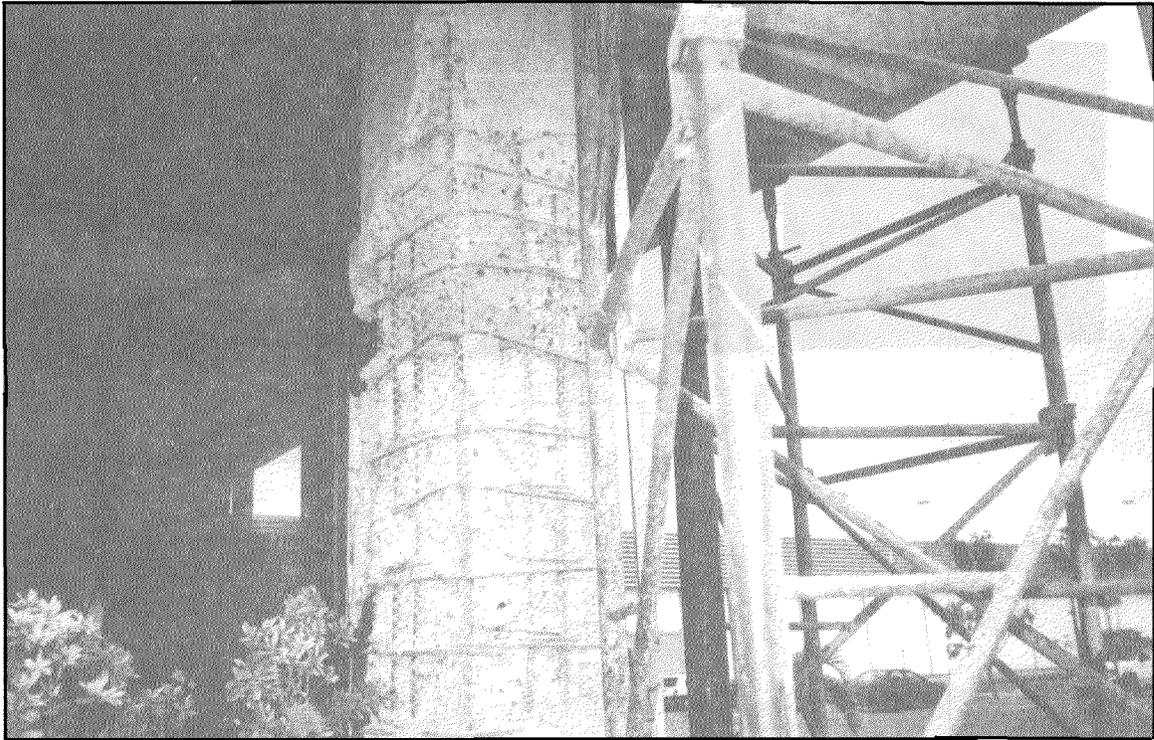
Desprendimiento del recubrimiento de la columna a causa del fuerte movimiento.
